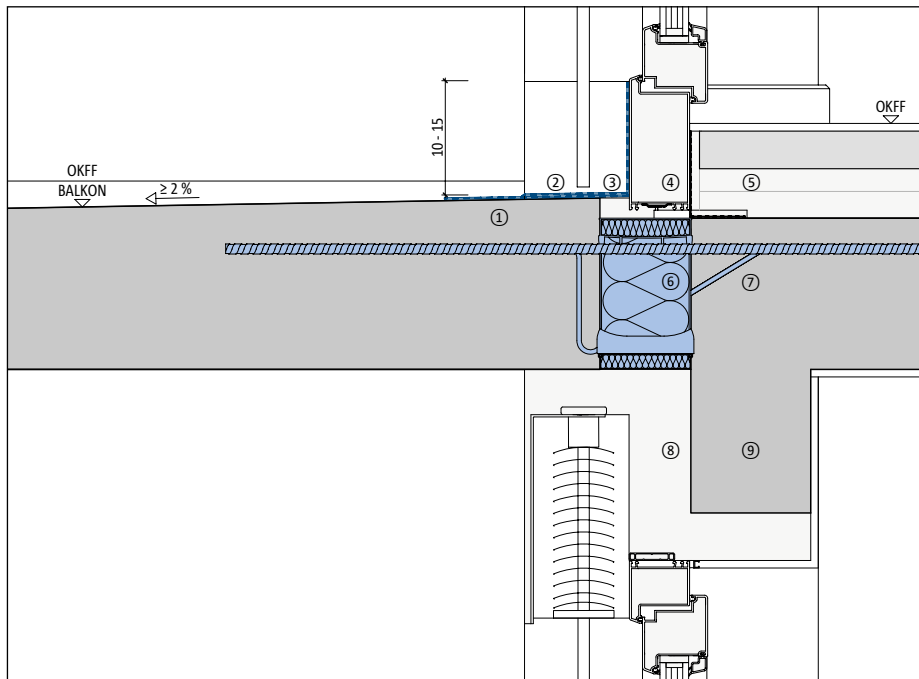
| M. 1:10 Fertigteilbalkon mit Aufbau
